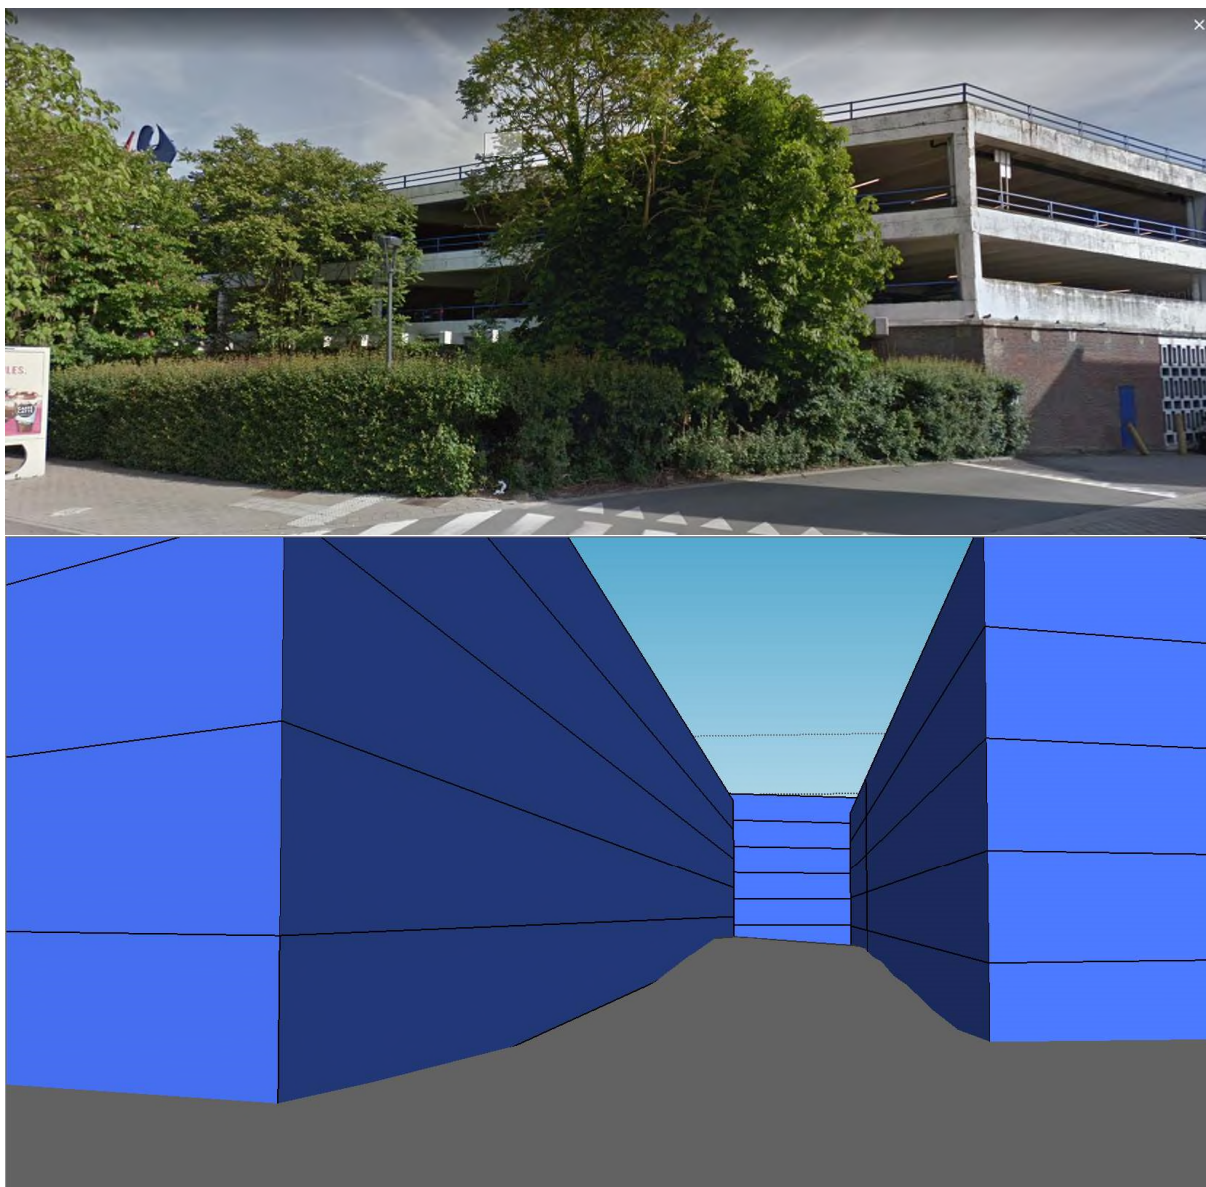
Vue depuis l'avenue Gustave Demey, vers le site, en situation existante (en haut) et projetée (en bas) (Google Street View et ORG², 2018)
